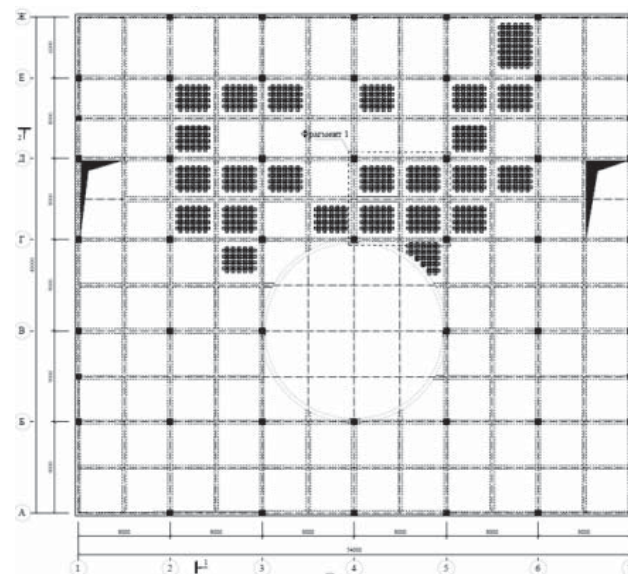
Схема расположения полос сеток усиления плиты перекрытия над нижним этажом
